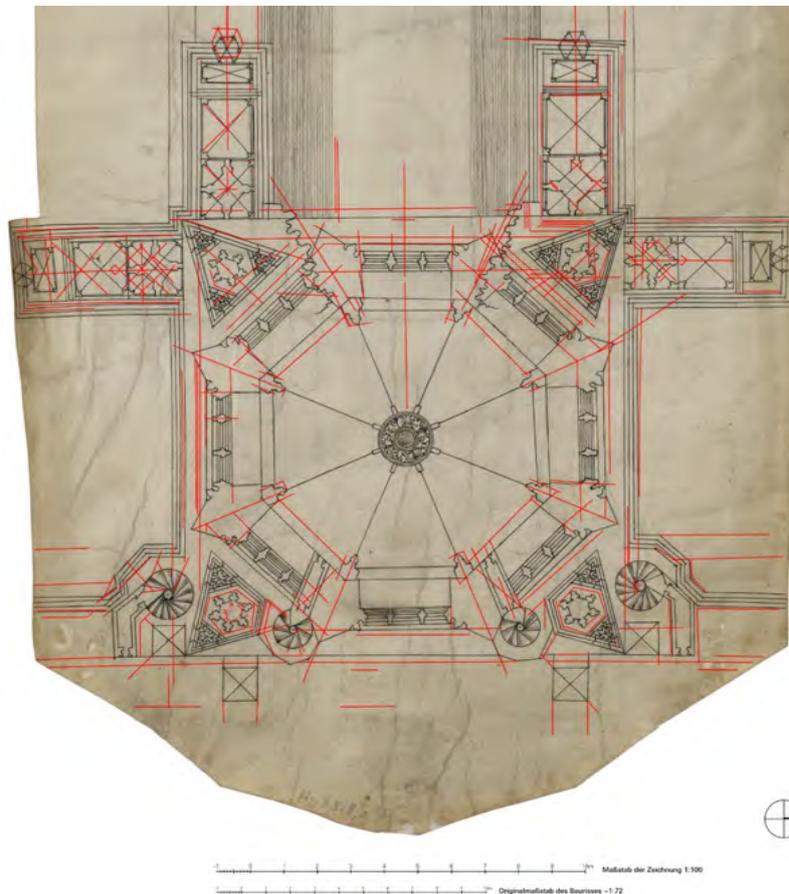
Nürnberger Riss, Grundriss mit eingetragenen Blindrillen in Rot.
